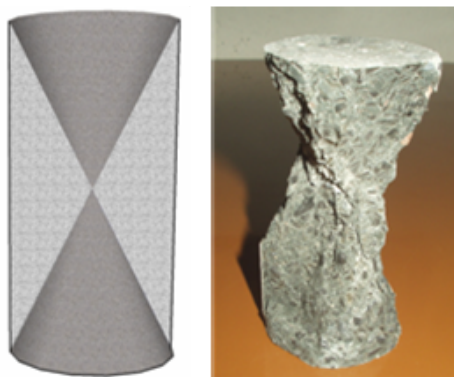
Ruptura cônica dos corpos-de-prova cilíndricos após ensaio de compressão axial.
